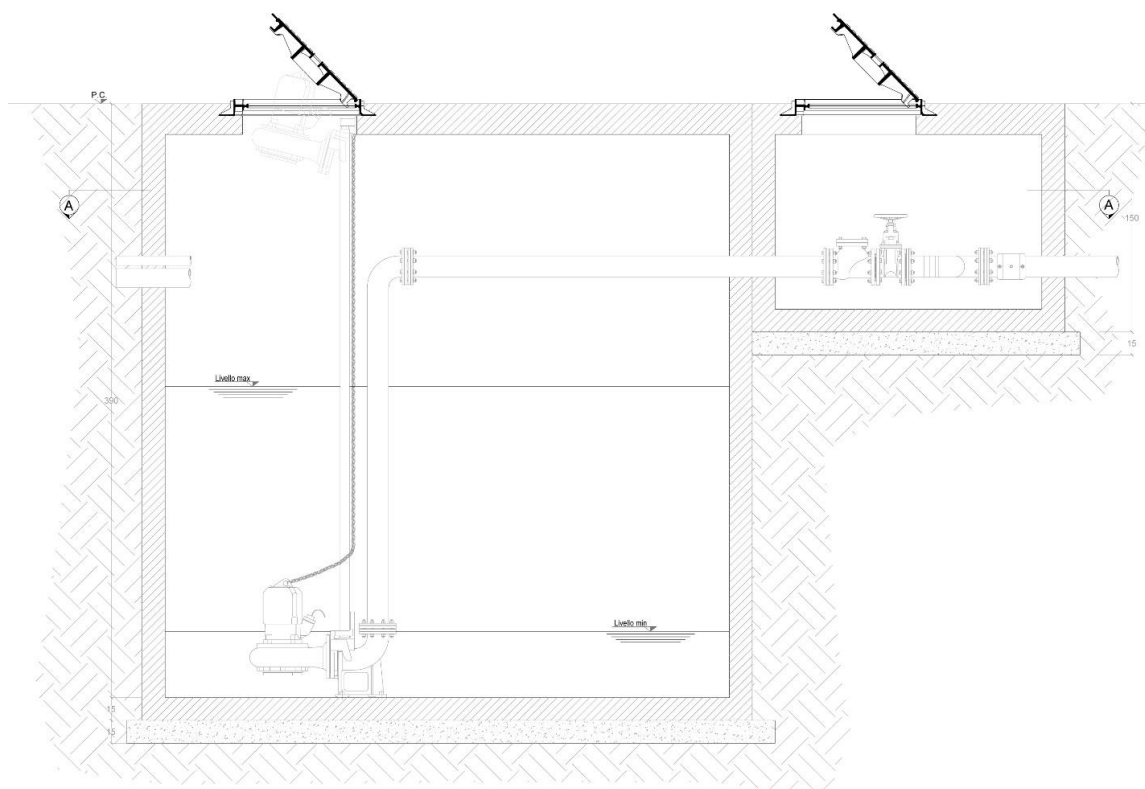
Stazioni di sollevamento con pozzetto contenente le apparecchiature idrauliche e di controllo.
